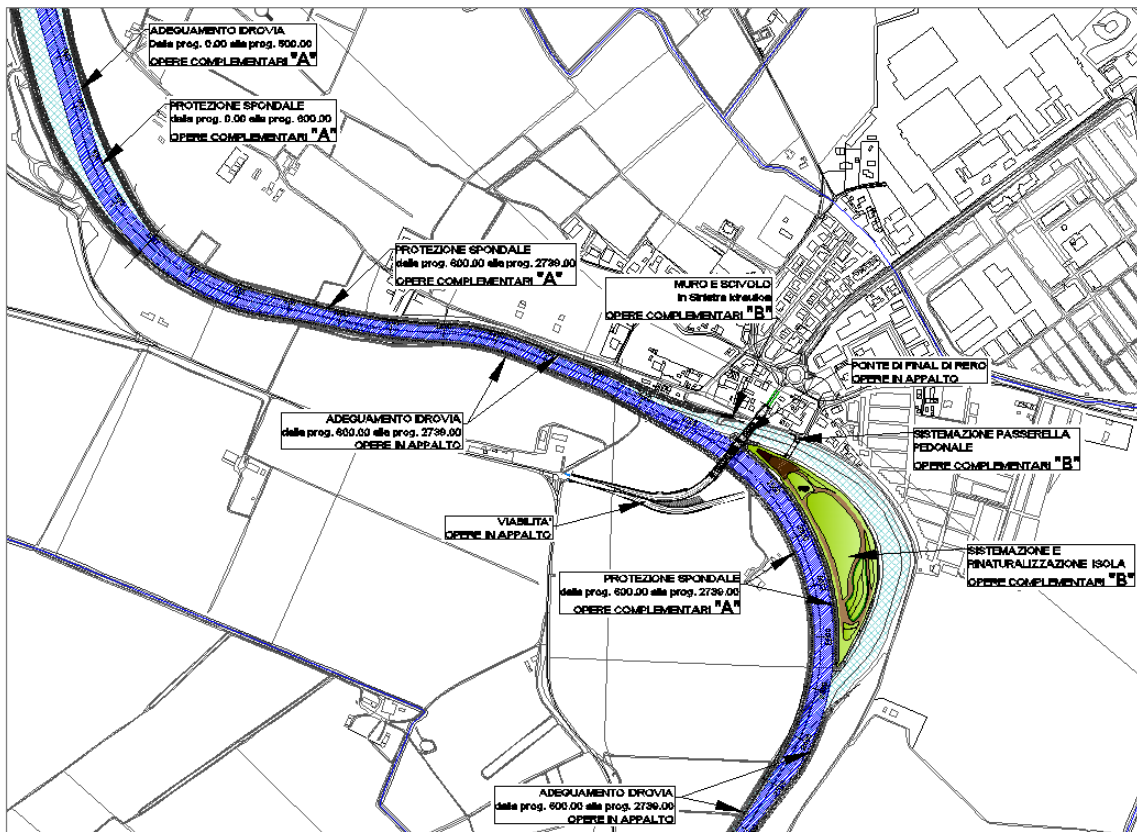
Rappresentazione planimetrica dell'area di intervento con indicazione delle parti d'opera appartenenti ai vari stralci di lavoro previsti
